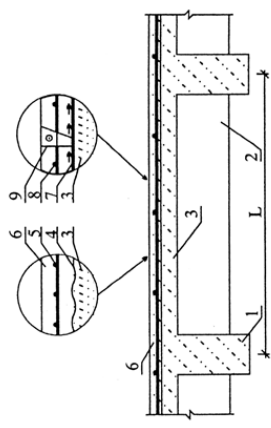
Zespolenie stropów z elementów prefabrykowanych za pomocą betonu ekspansyjnego
